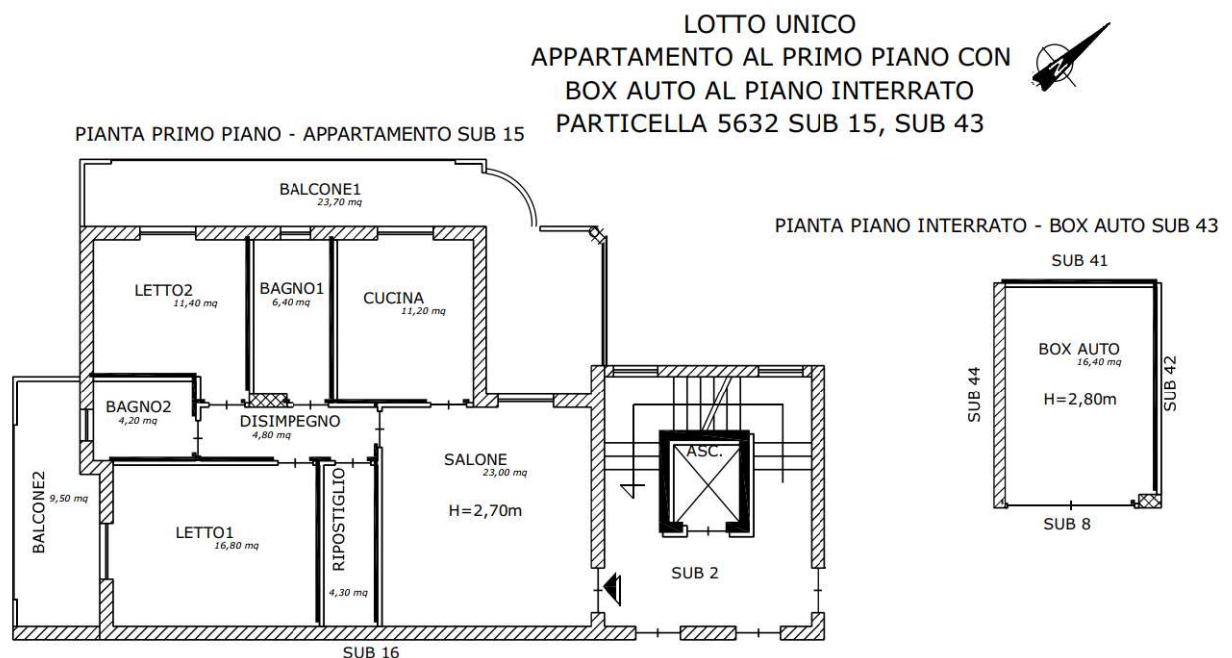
planimetria dell'appartamento al primo piano con il box auto al piano interrato
